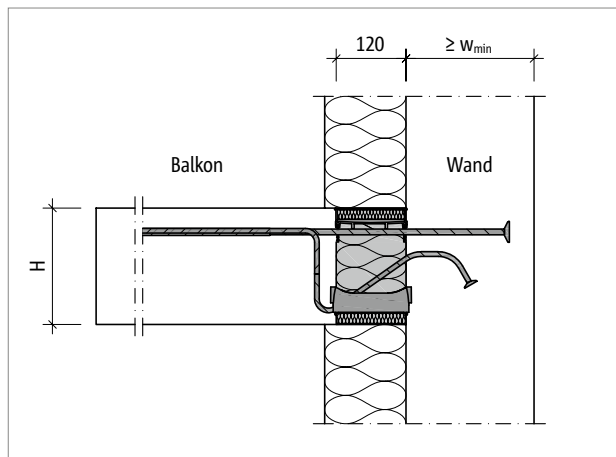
Schöck Isokorb® XT Typ KL-U: Wandanschluss nach oben bei Außen-dämmung
